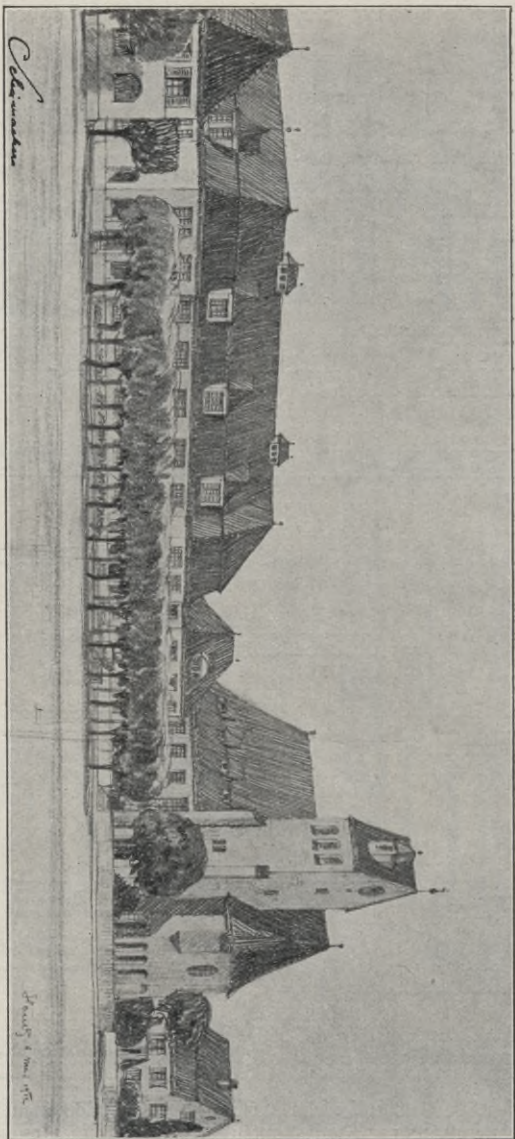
Studie zu der Platzgestaltung (Staatsbauten) des Bebauungsplanes Abb. 2. Zu Variante I (Abb. 5).
